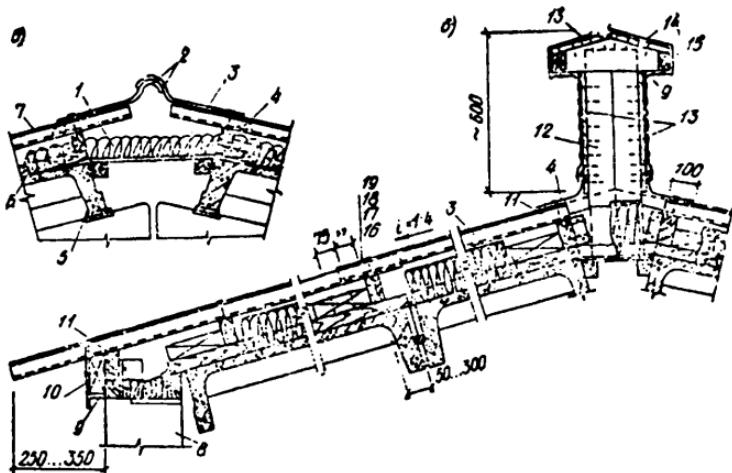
Совмещенное вентилируемое покрытие с асбестоцементной кровлей:
